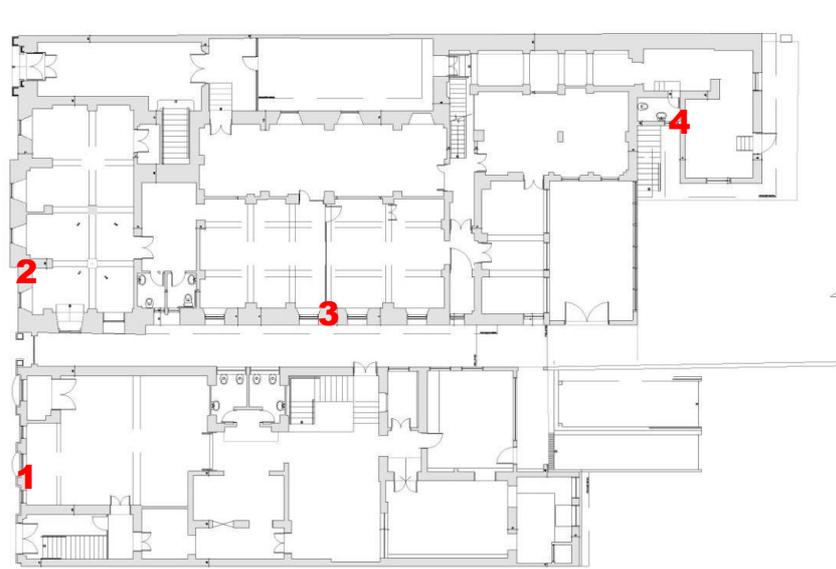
Planta baixa com a localização das prospecções no pavimento térreo
